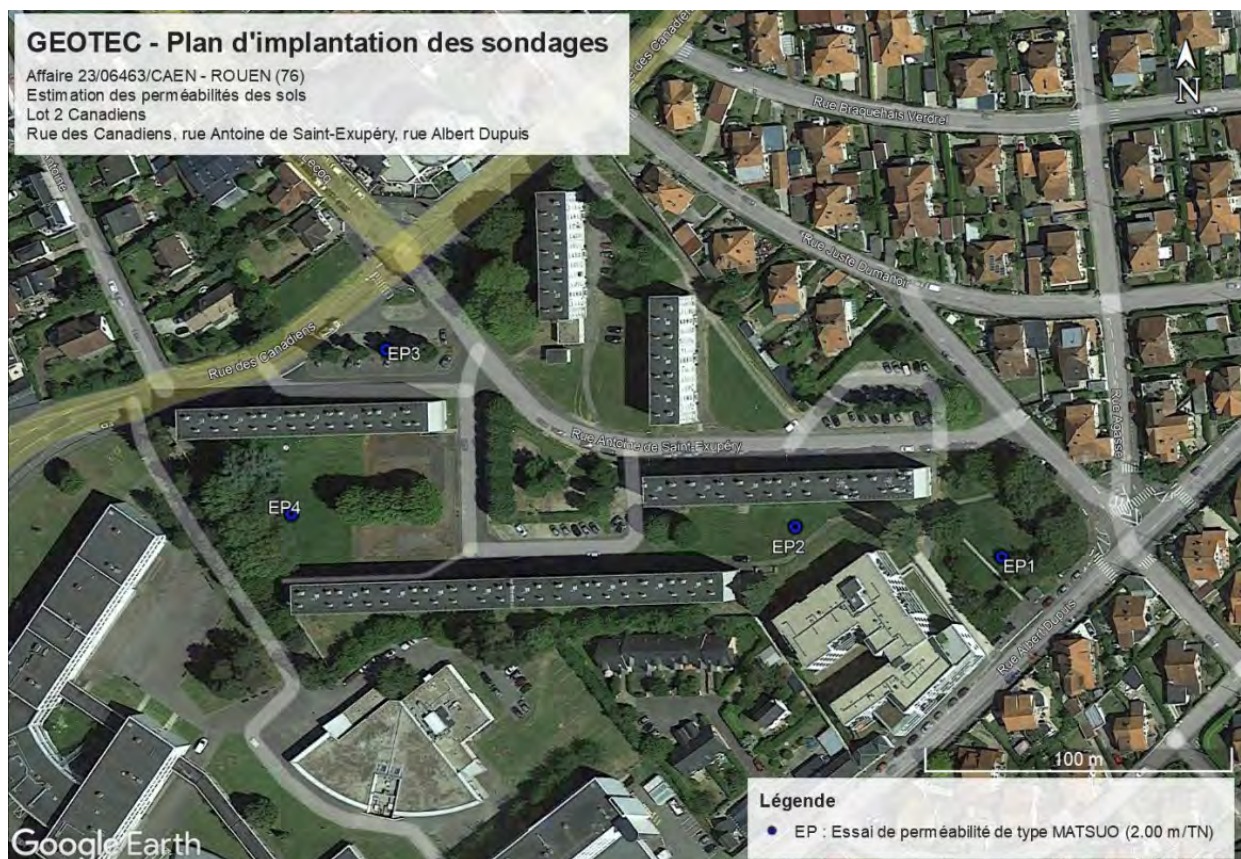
LOCALISATION DES ESSAIS MATSUO (SOURCE : GEOTEC)
